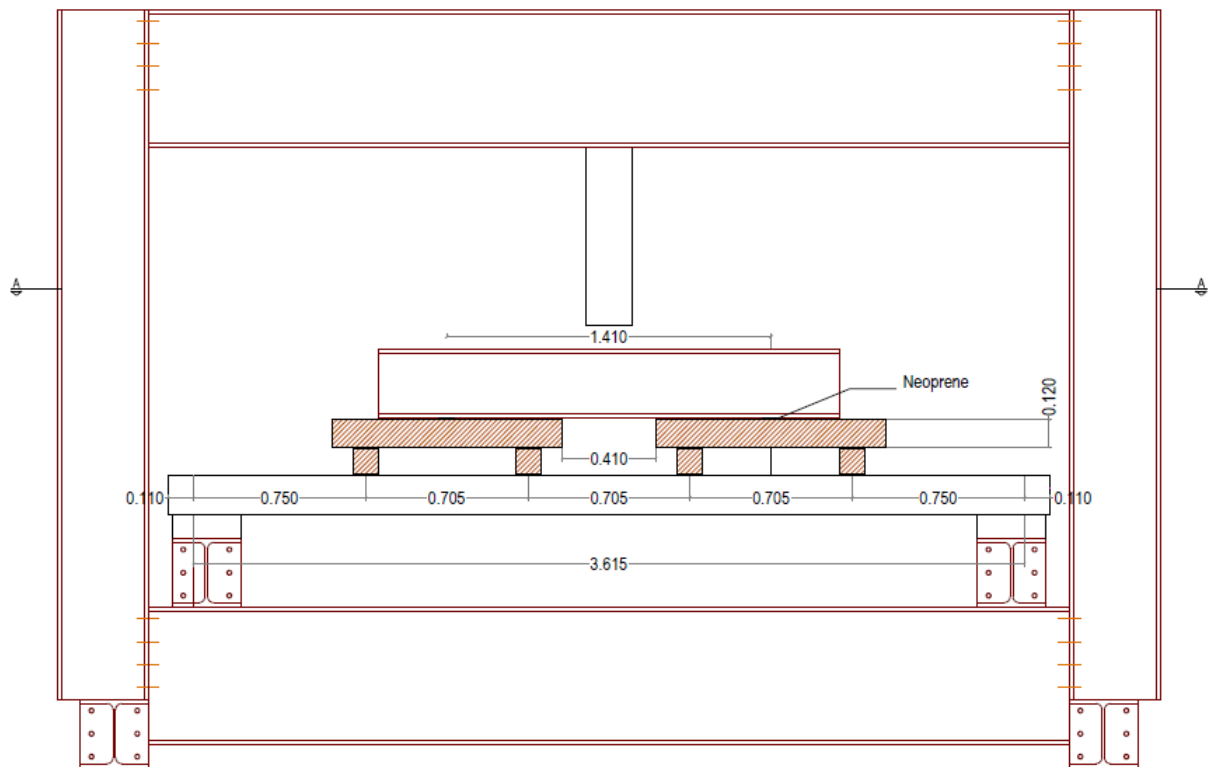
Vista lateral do esquema de ensaio (dimensões em m)
